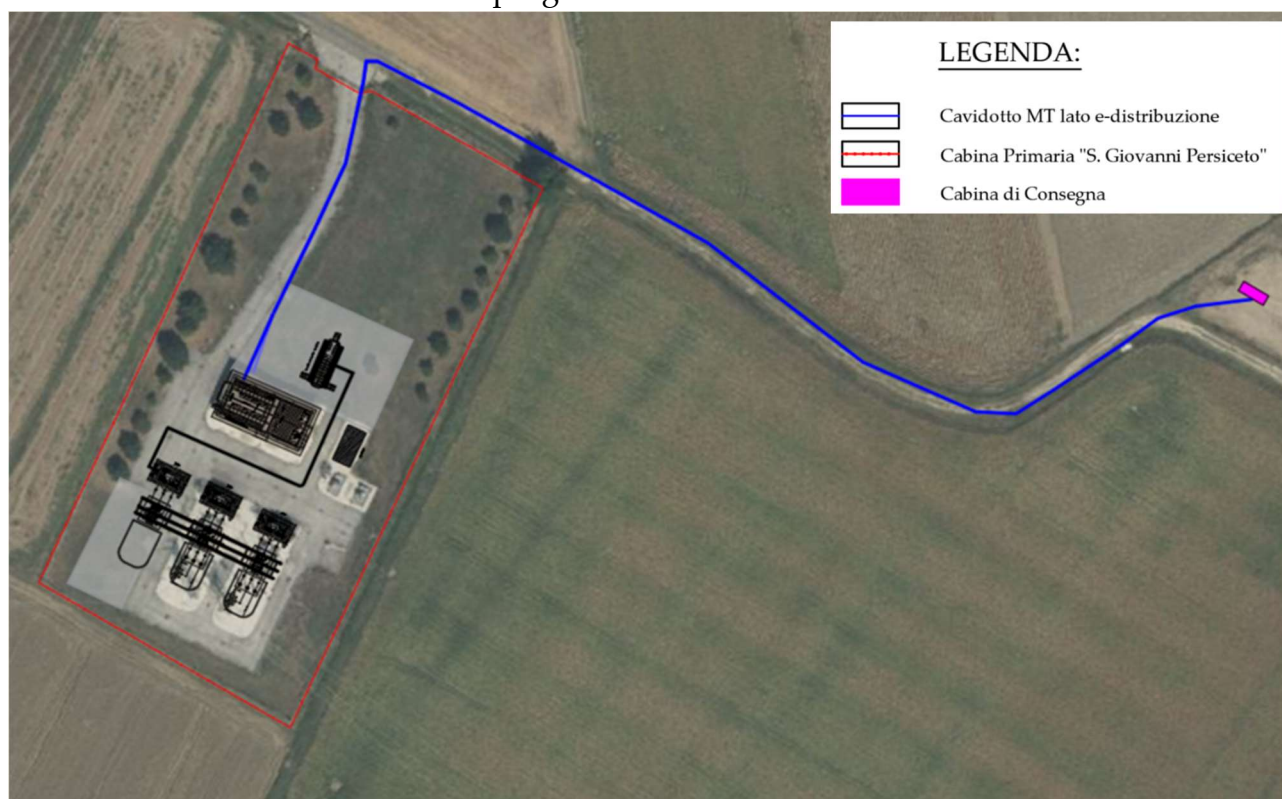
Particolare ortofoto posizionamento cabine elettriche ed opere di rete in progetto
